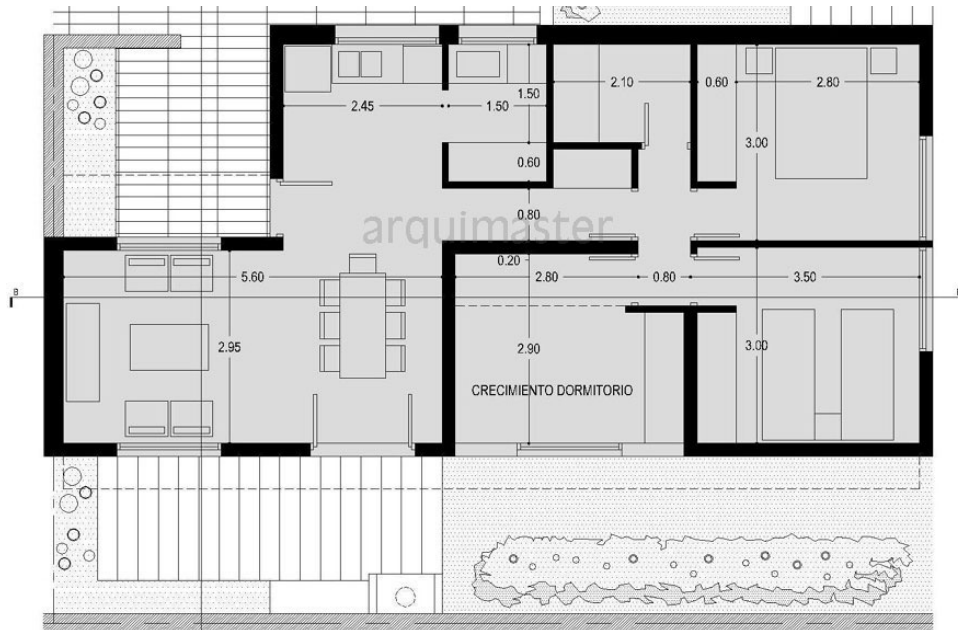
Plantas baixa protótipo 02, edificação térrea.
